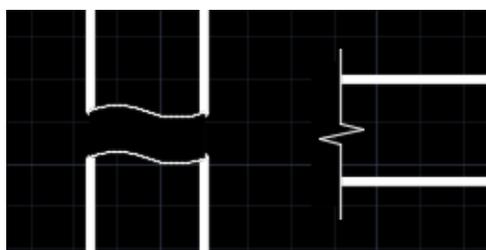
Команды «Криволинейный разрыв» и «Линейный обрыв»
